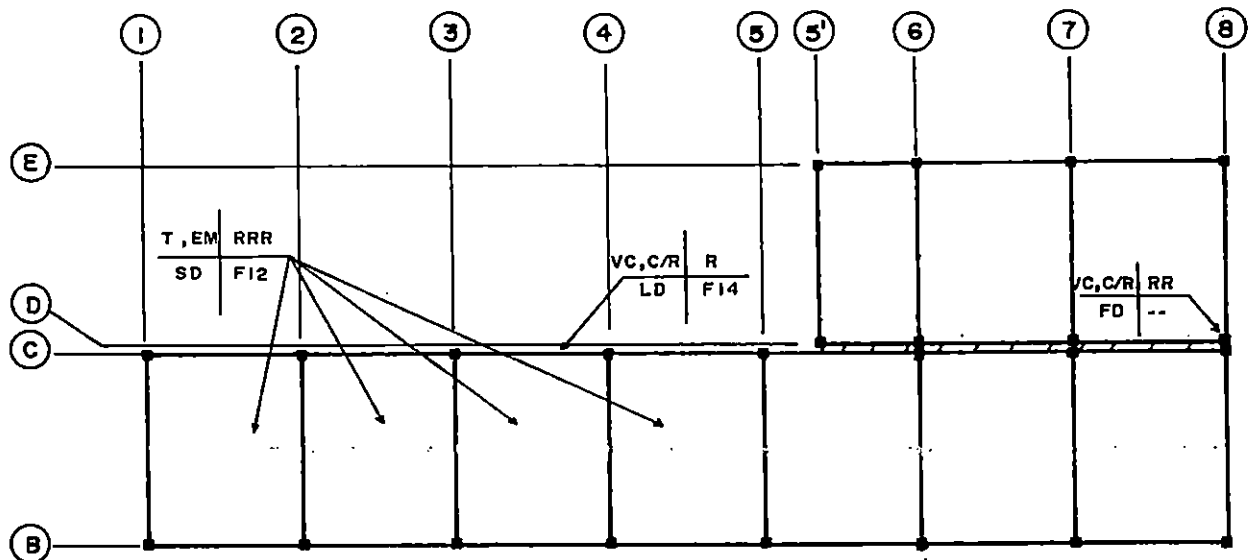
PLANO DE DAÑOS "TECHO Y VIGA CANAL"
